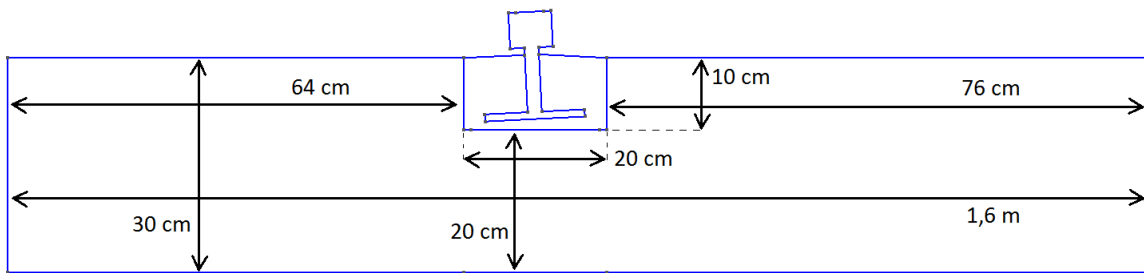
Géométrie et dimensions de la couche d'enrobé bitumineux
